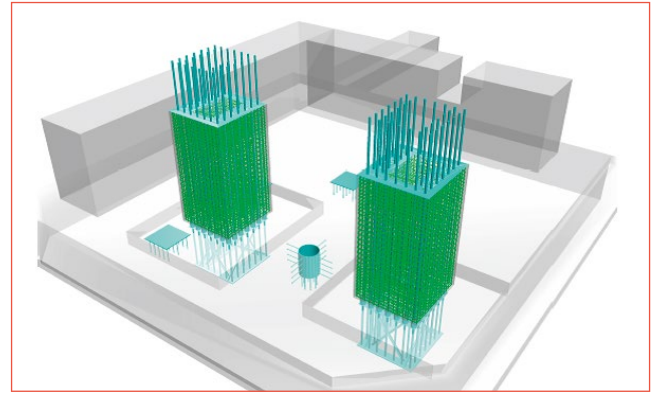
Render 3D delle strutture in cemento armato (pilastri, muro di reazione, fondazione)
